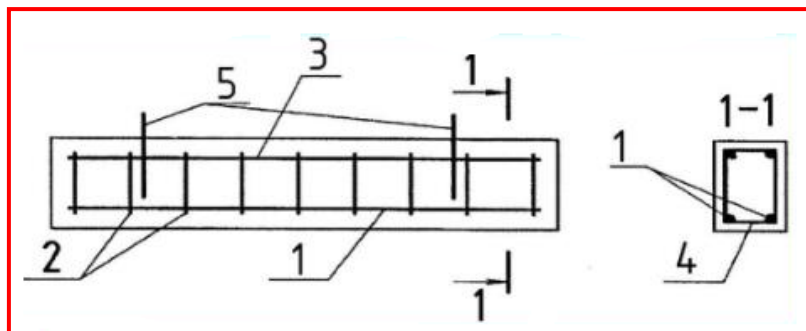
Креслення залізобетонної балки: 1 – робоча арматура; 2, 4 – поперечні стержні (хомути); 3 – розподільча арматура; 5 – монтажні стержні
